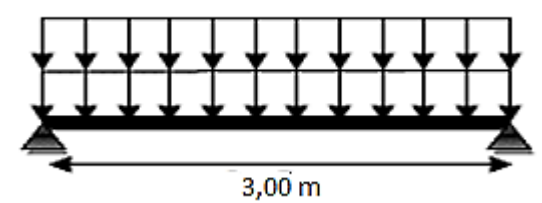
Disposition constrictive de la dalle de compression.
